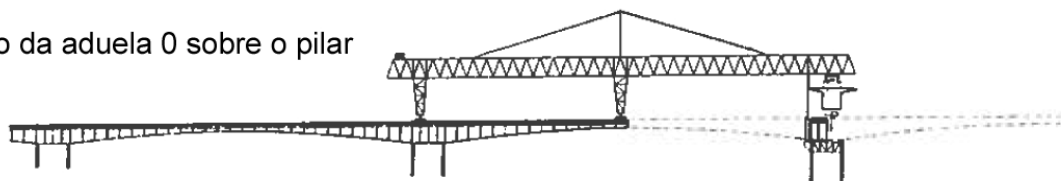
Colocação da aduela 0 sobre o pilar.
